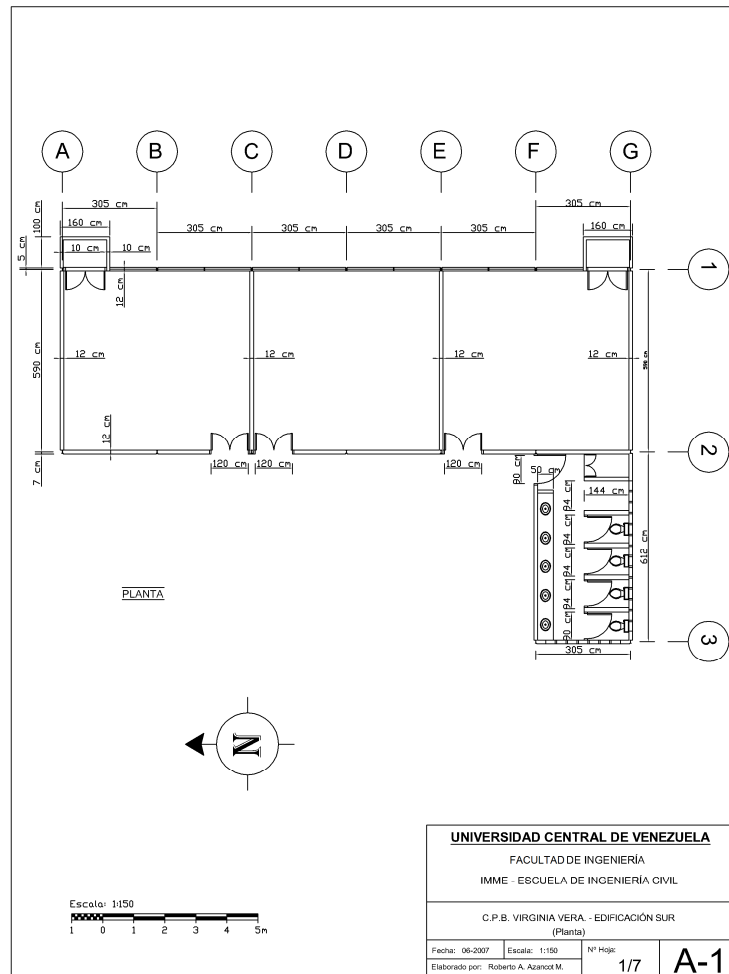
Plano A1: Plano Arquitectónico de la Planta
